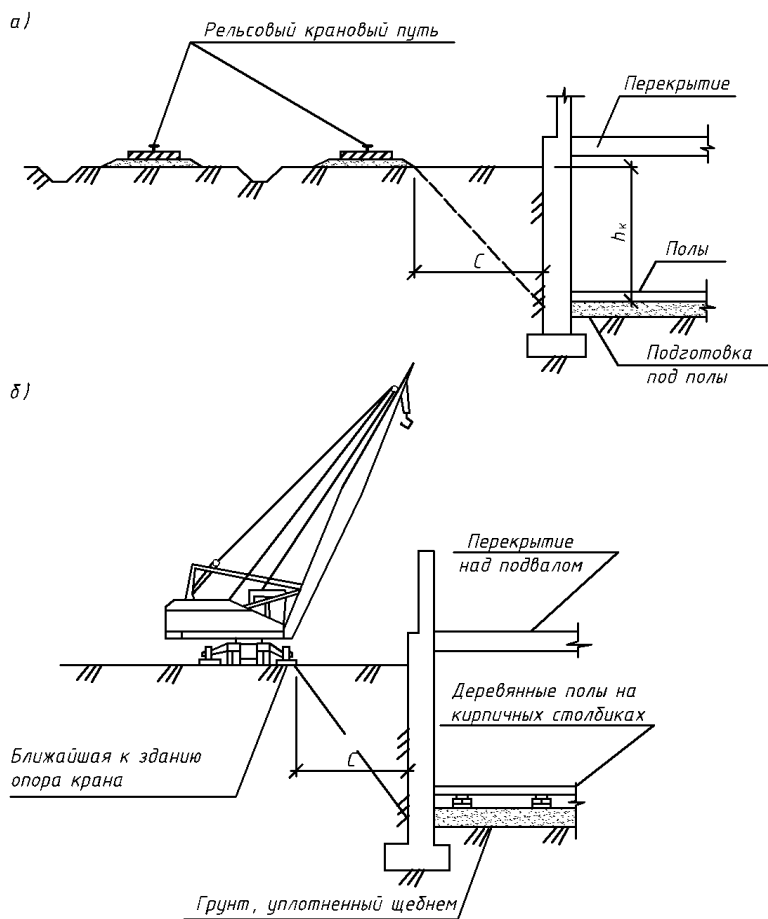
Установка кранов у зданий с подвалом без расчета выдавливания стен от крановых нагрузок:
